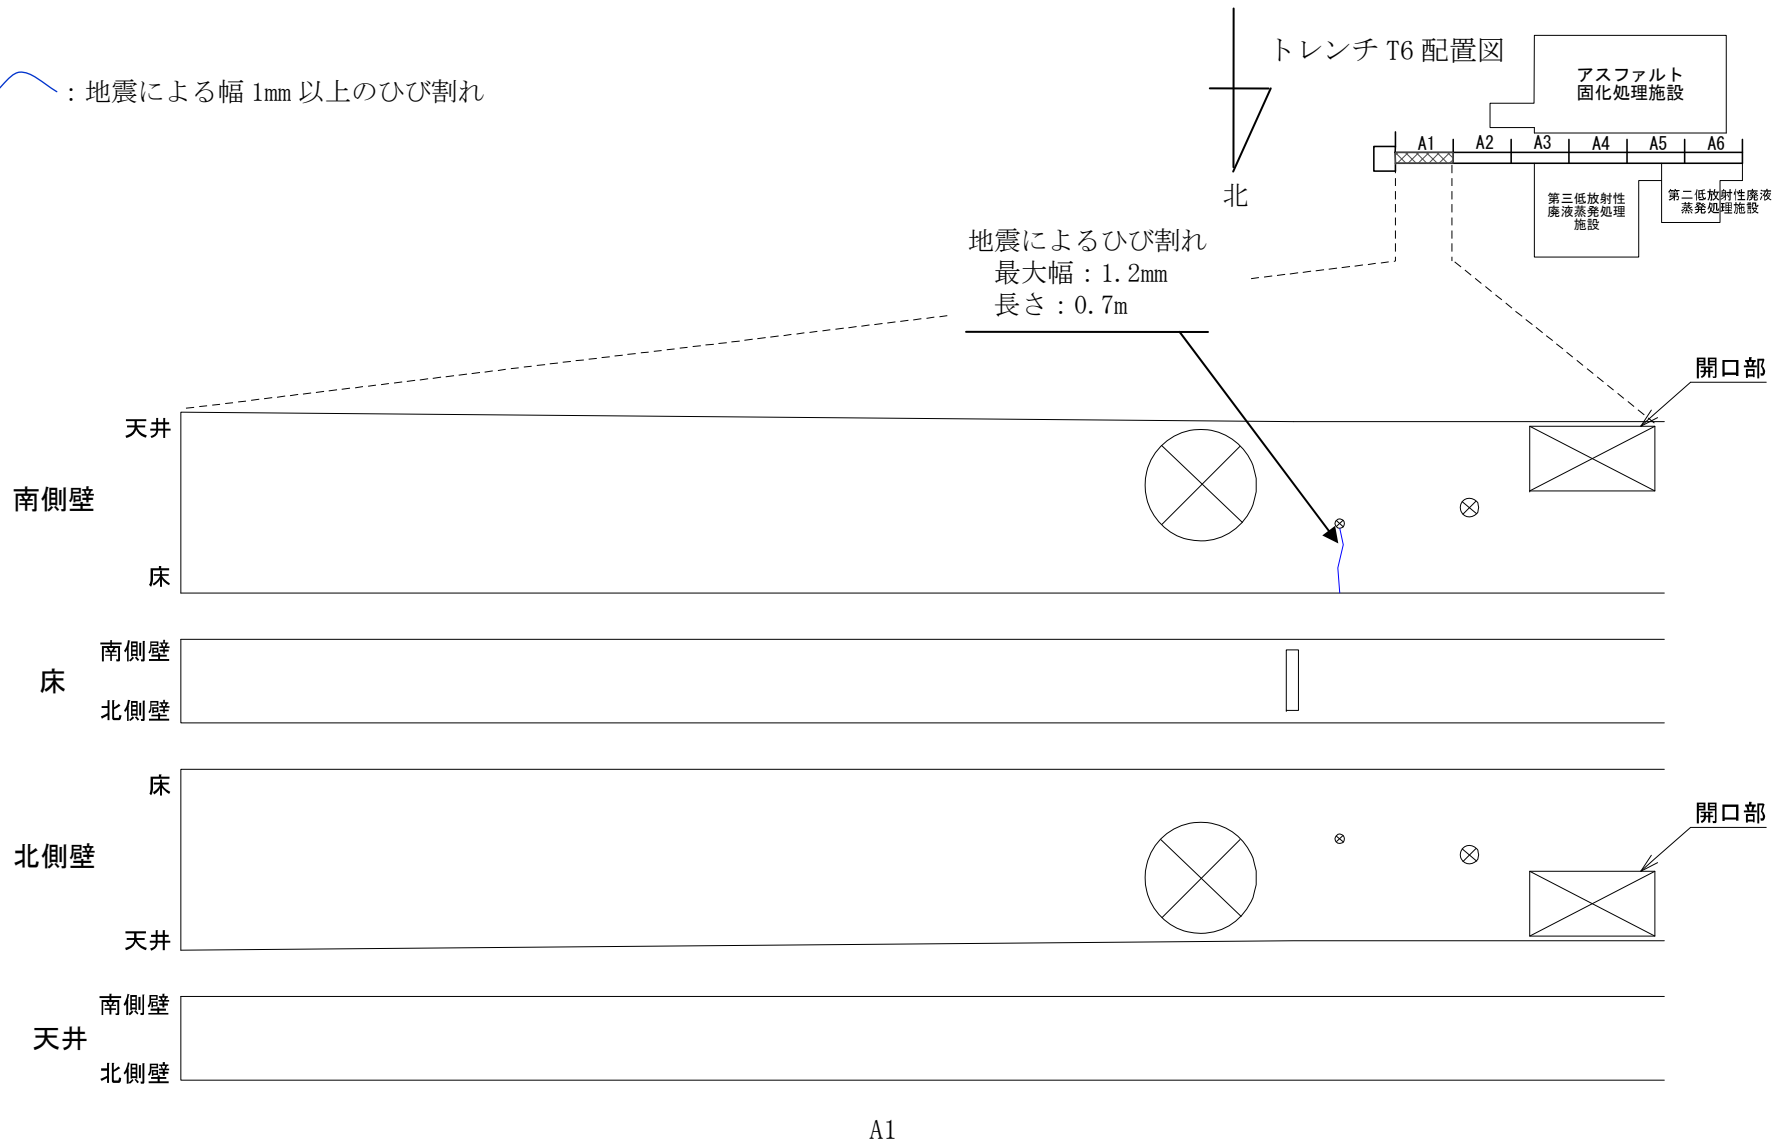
ひび割れの発生状況 トレンチ T6
